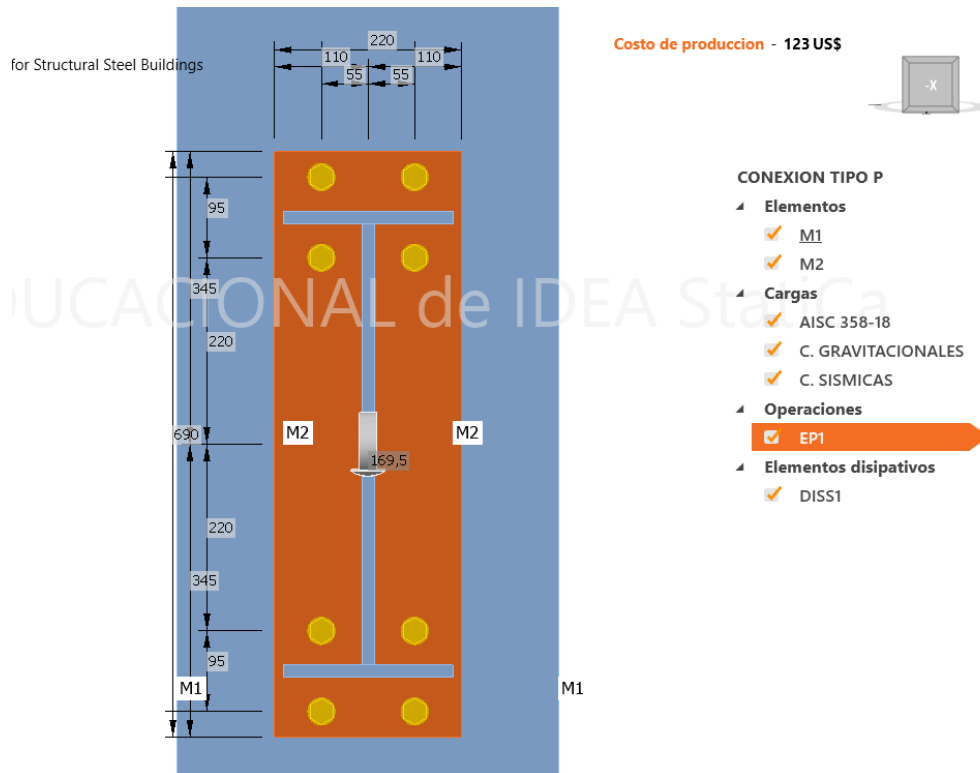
Sección transversal (Placa final) IDEA StatiCa V23.0.1
